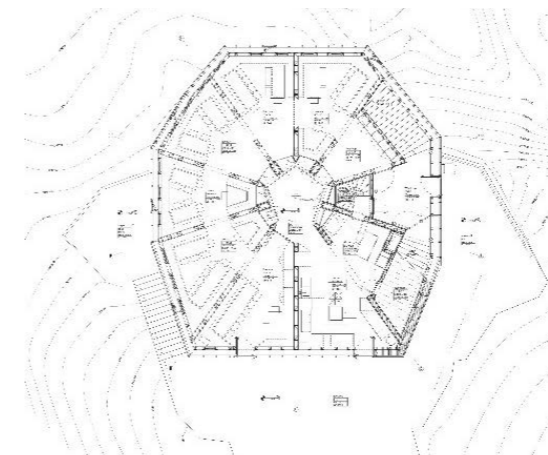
Pianta piano terra Monte Rosa Hutte.
